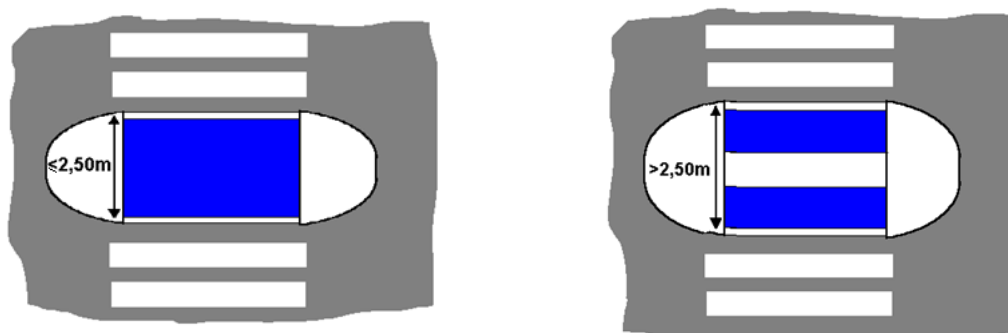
Pavimento tátil nos refúgios ou separadores centrais
